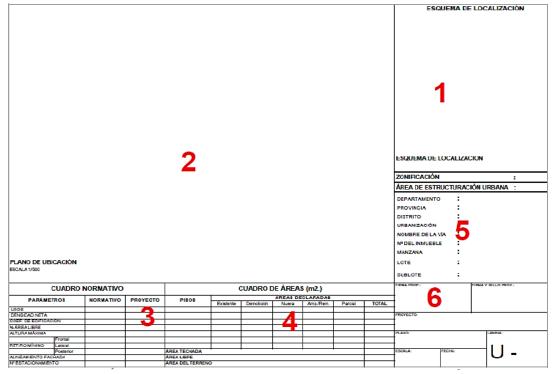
Plano de ubicación y localización. Fuente: Autoría propia.
